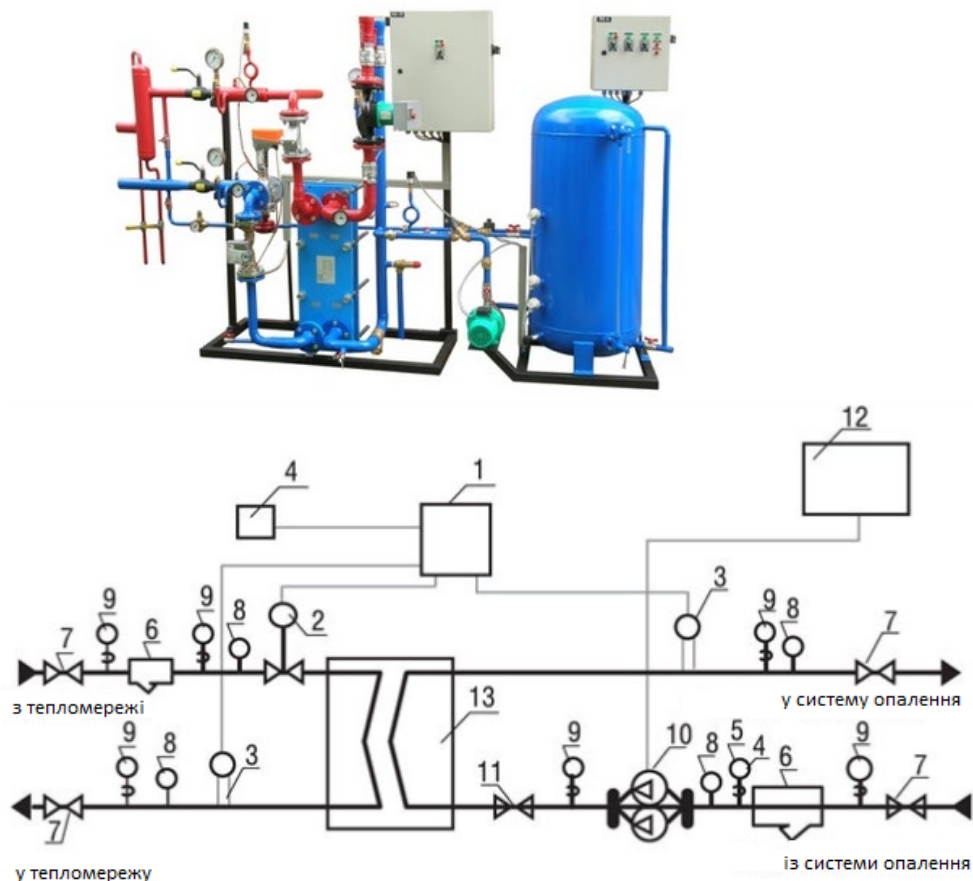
Зовнішній вигляд та принципова схема блочного ІТП:
